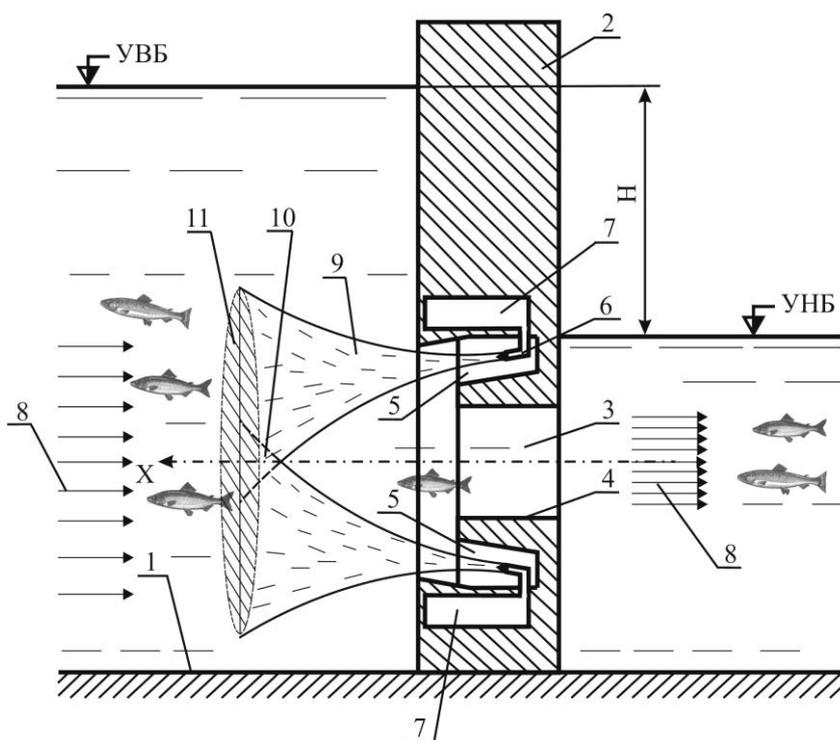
Схема конструкции вливного отверстия с глухой галереей, продольный разрез: 1 – рыбоходный тракт; 2 – вертикальная поперечная разделительная стенка; 3 – вливное отверстие; 4 – потокоформирующий фартук; 5 – глухие галереи; 6 – струеобразующие насадки; 7 – напорные коллекторы; 8 – привлекающий поток; 9 – гидравлические струи; 10 – суммарный поток; 11 – зона «частично равных давлений»
